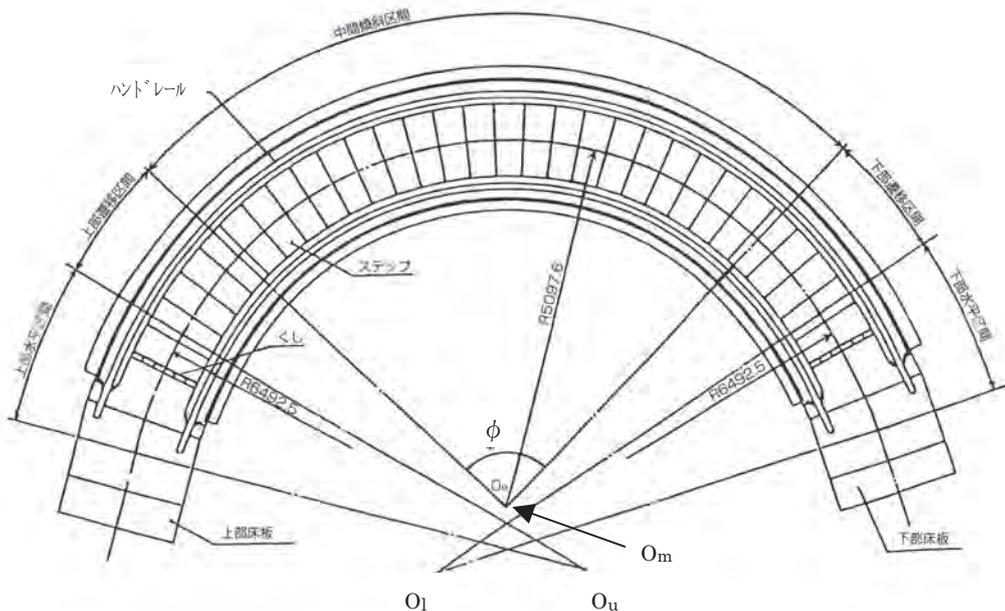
スパイラルエスカレーターの平面図 原図：注(14)
